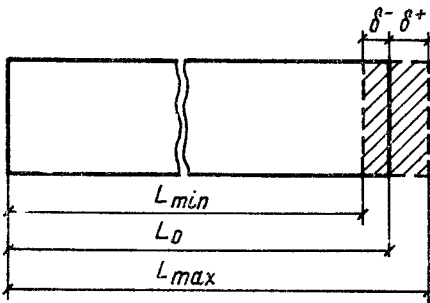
Схема отклонений бетонных и железобетонных изделий от проектного размера
